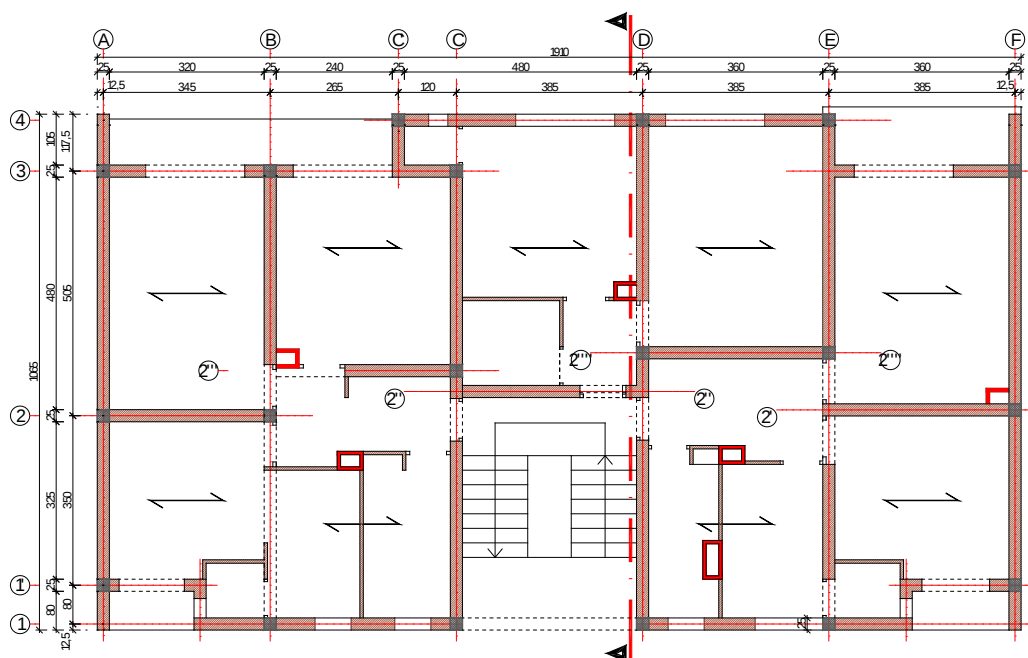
Planimetria e katit karakteristik të ndërtesës D2, M4H – Muraturë me kufizime BA
